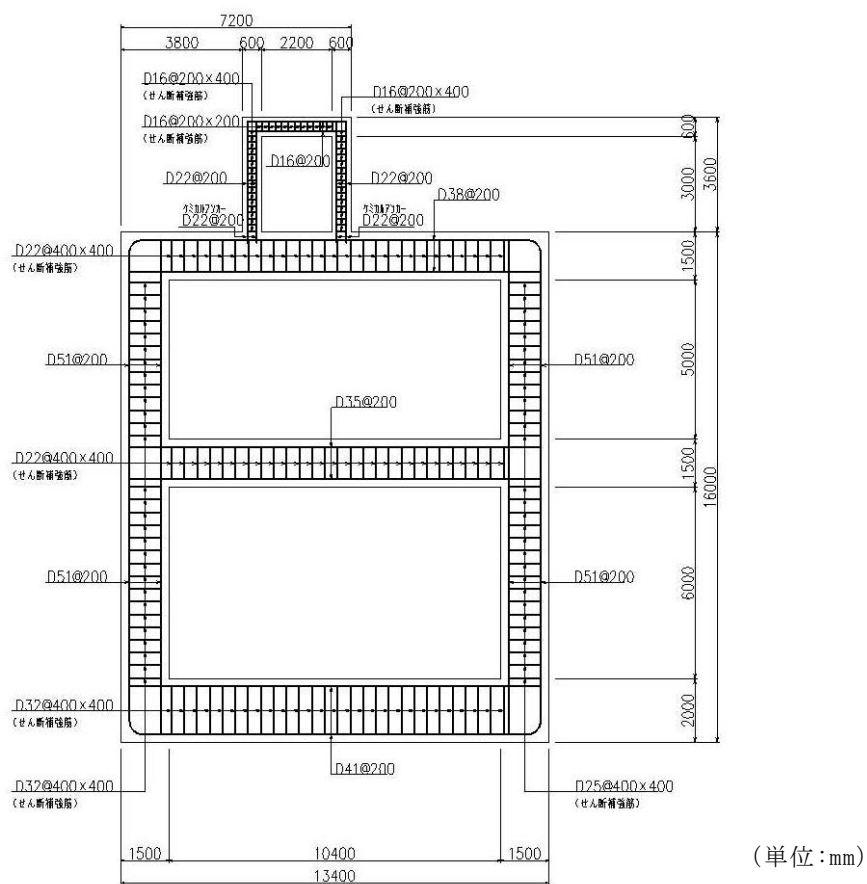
低圧原子炉代替注水ポンプ格納槽 概略配筋図 (A-A 断面)
